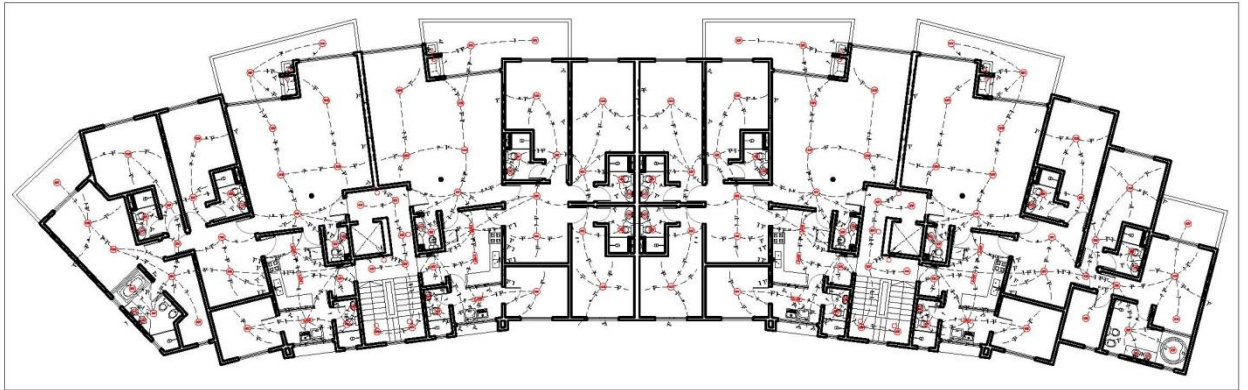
Planta baixa do projeto elétrico do pavimento tipo do bloco 02.
